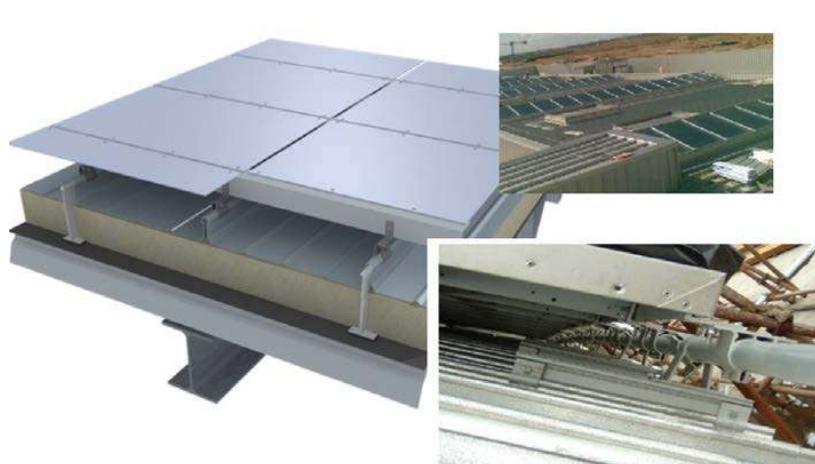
Ejemplo de cubierta deck con sistema engatillado
